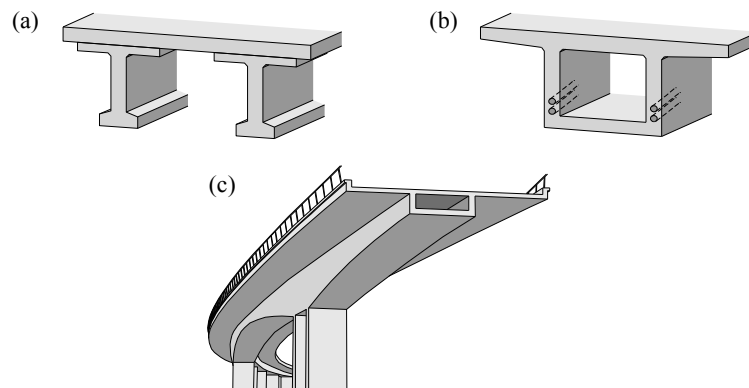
Potentiell schubkritische Stahlbeton- und Spannbetonelemente: (a) Stahlbeton- oder Spannbetonträger mit dünnem Trägersteg; (b) dünnwandiger Steg eines vorgespannten Kastenbrückenträgers und (c) Kastenbrückenträger.
